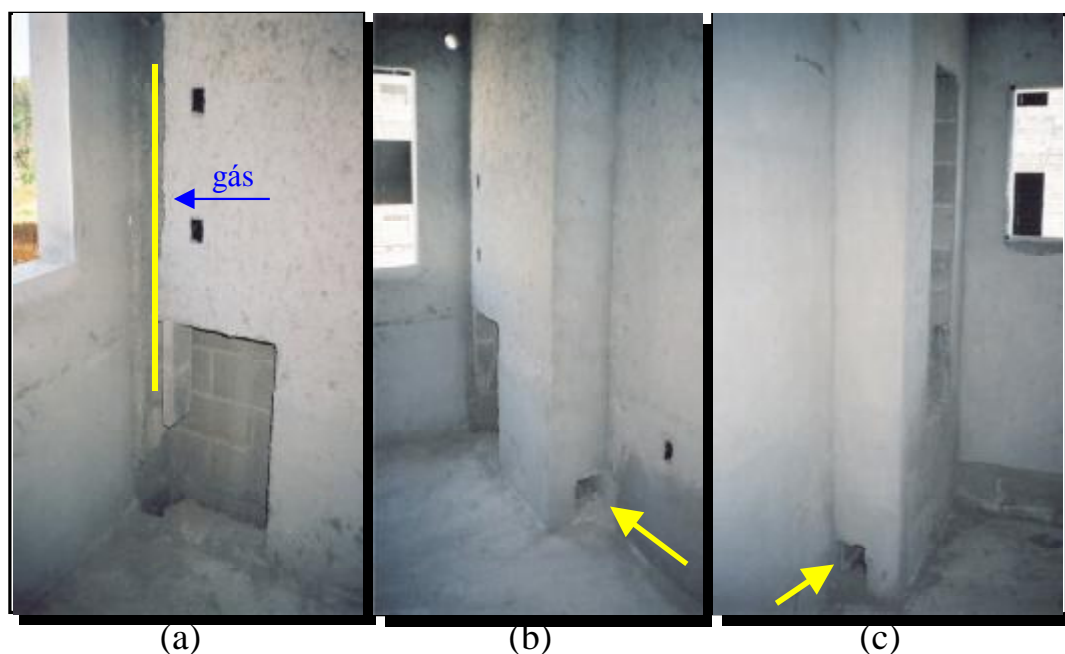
Shafts* para instalações hidrossanitárias a serem instaladas externas à alvenaria.
